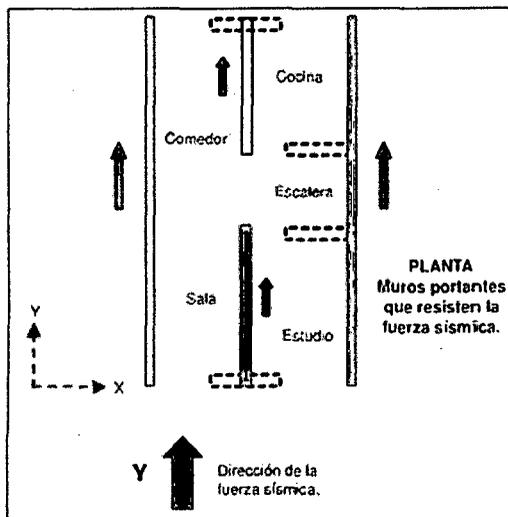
Muro en la dirección "Y" soportando la fuerza del sismo.
